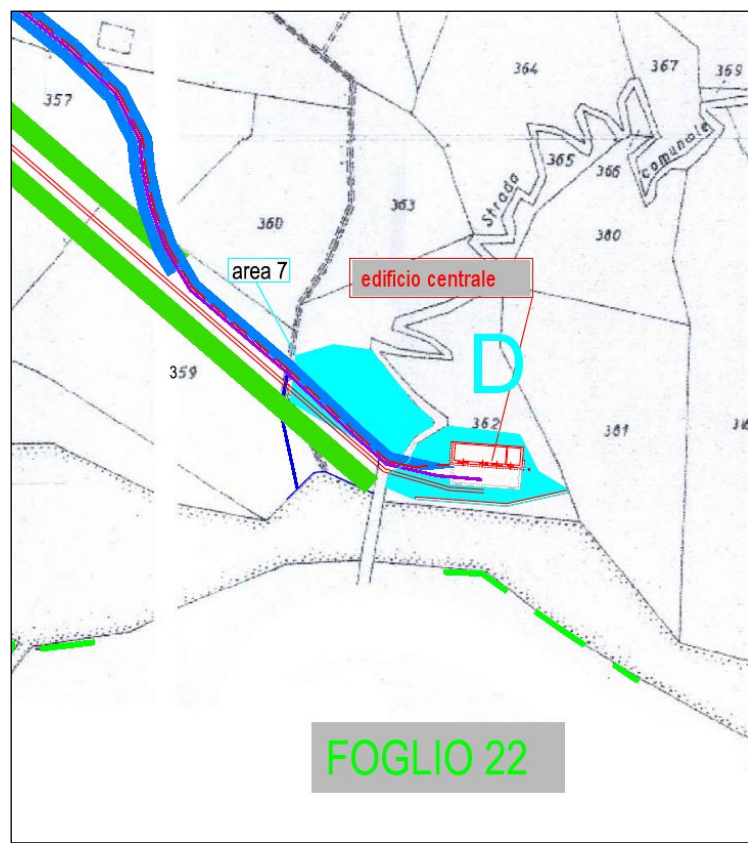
Stralcio planimetria recupero ambientale con vecchia posizione centralina
